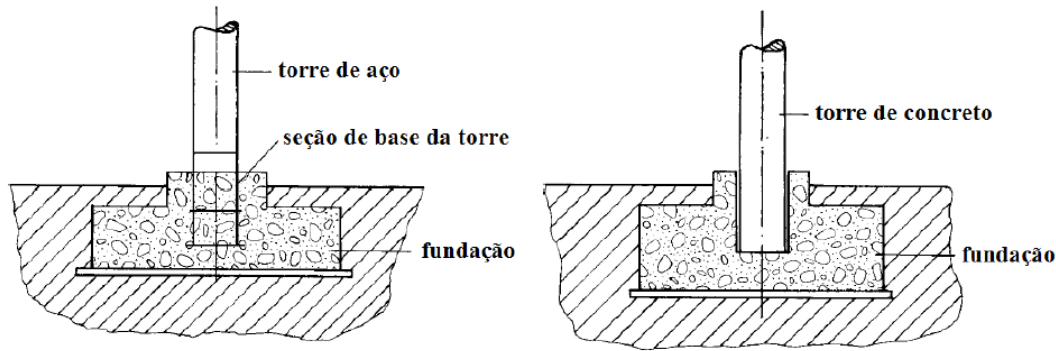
Fundação em sapata para uma torre de aço e uma torre pré-fabricada de concreto (adaptado de HAU, 2006).
